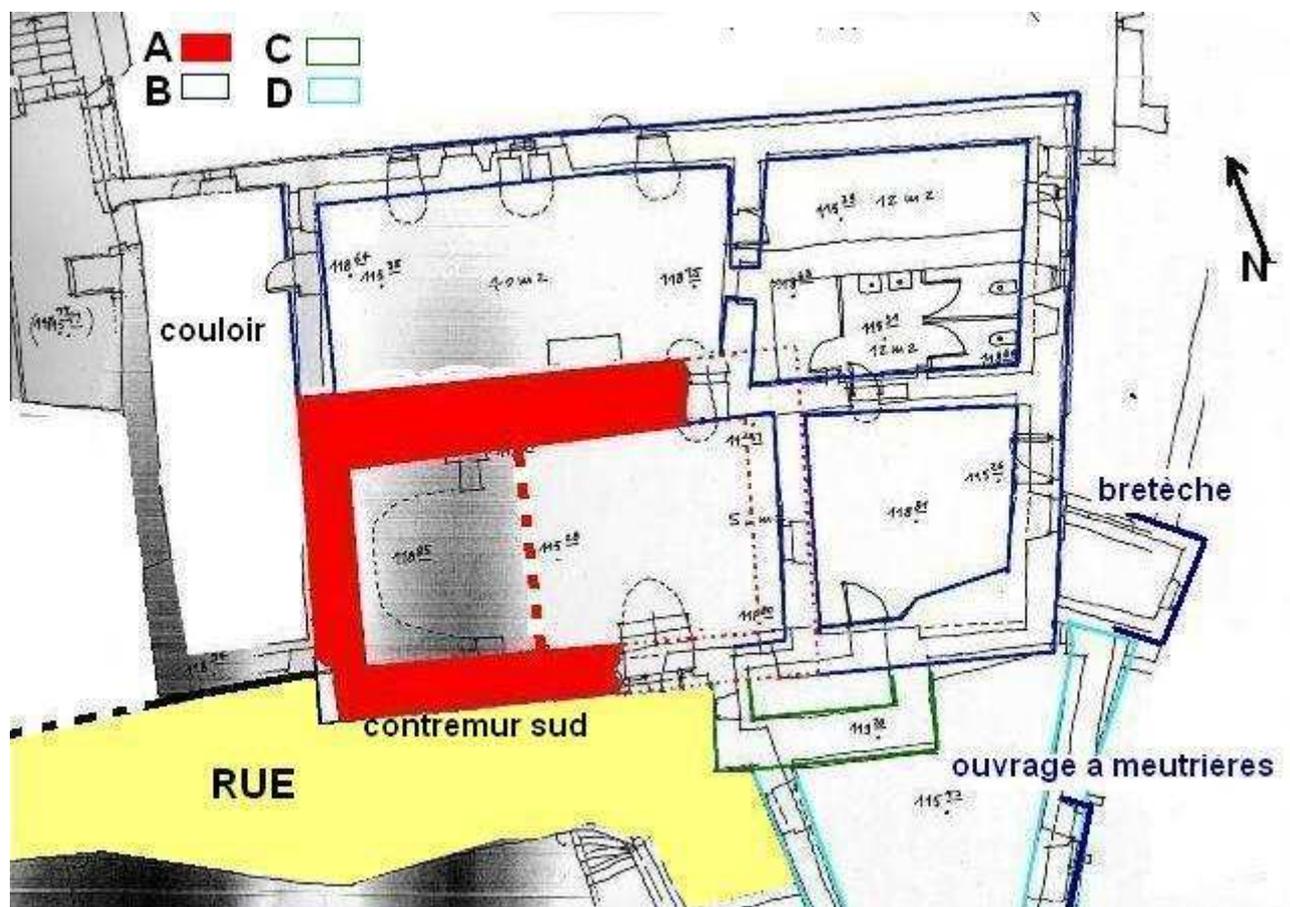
(suêrposition des plans du rez-de-chaussée et de l'étage)
